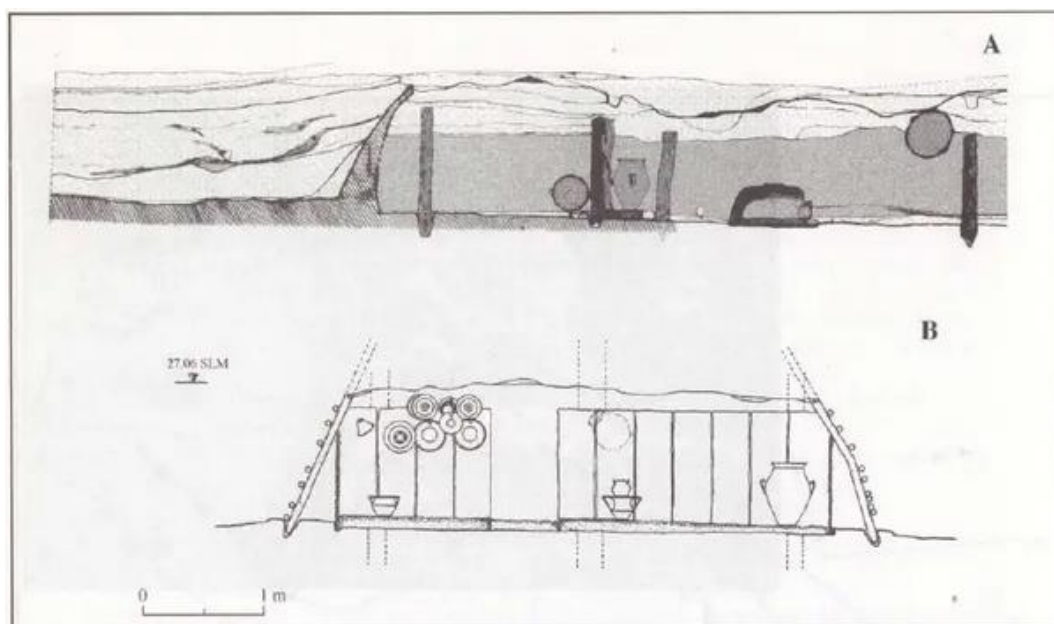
Sections de la maison 4 ; section longitudinale (A) ; section transversale (B) (Albore Livadie et al., 2005).
